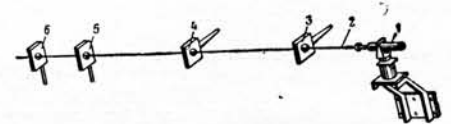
Схема установки лазерного устройства и визирных марок при проходке тоннеля. 1 — лазерный прибор, 2 — лазерный луч, 3, 4 — визирные марки по направлению лазерного луча, 5, 6 — задняя и передняя марки на машине.
